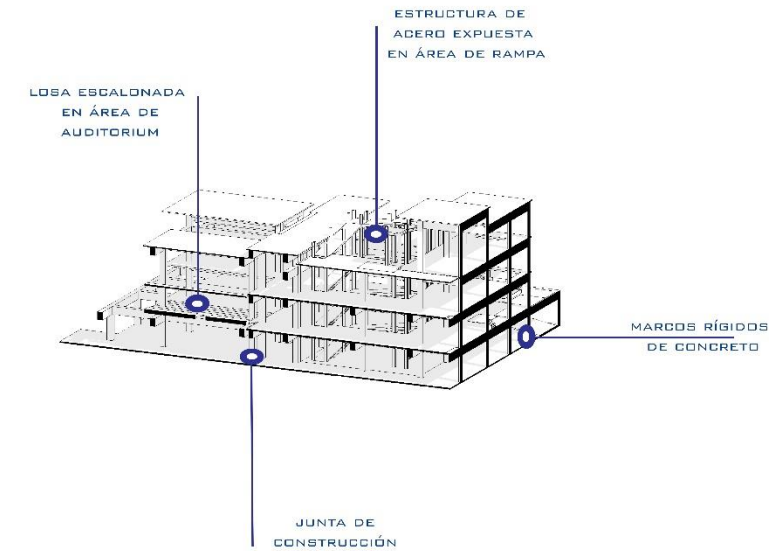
Detalle Estructural 3D. Fuente: Elaboración propia.
